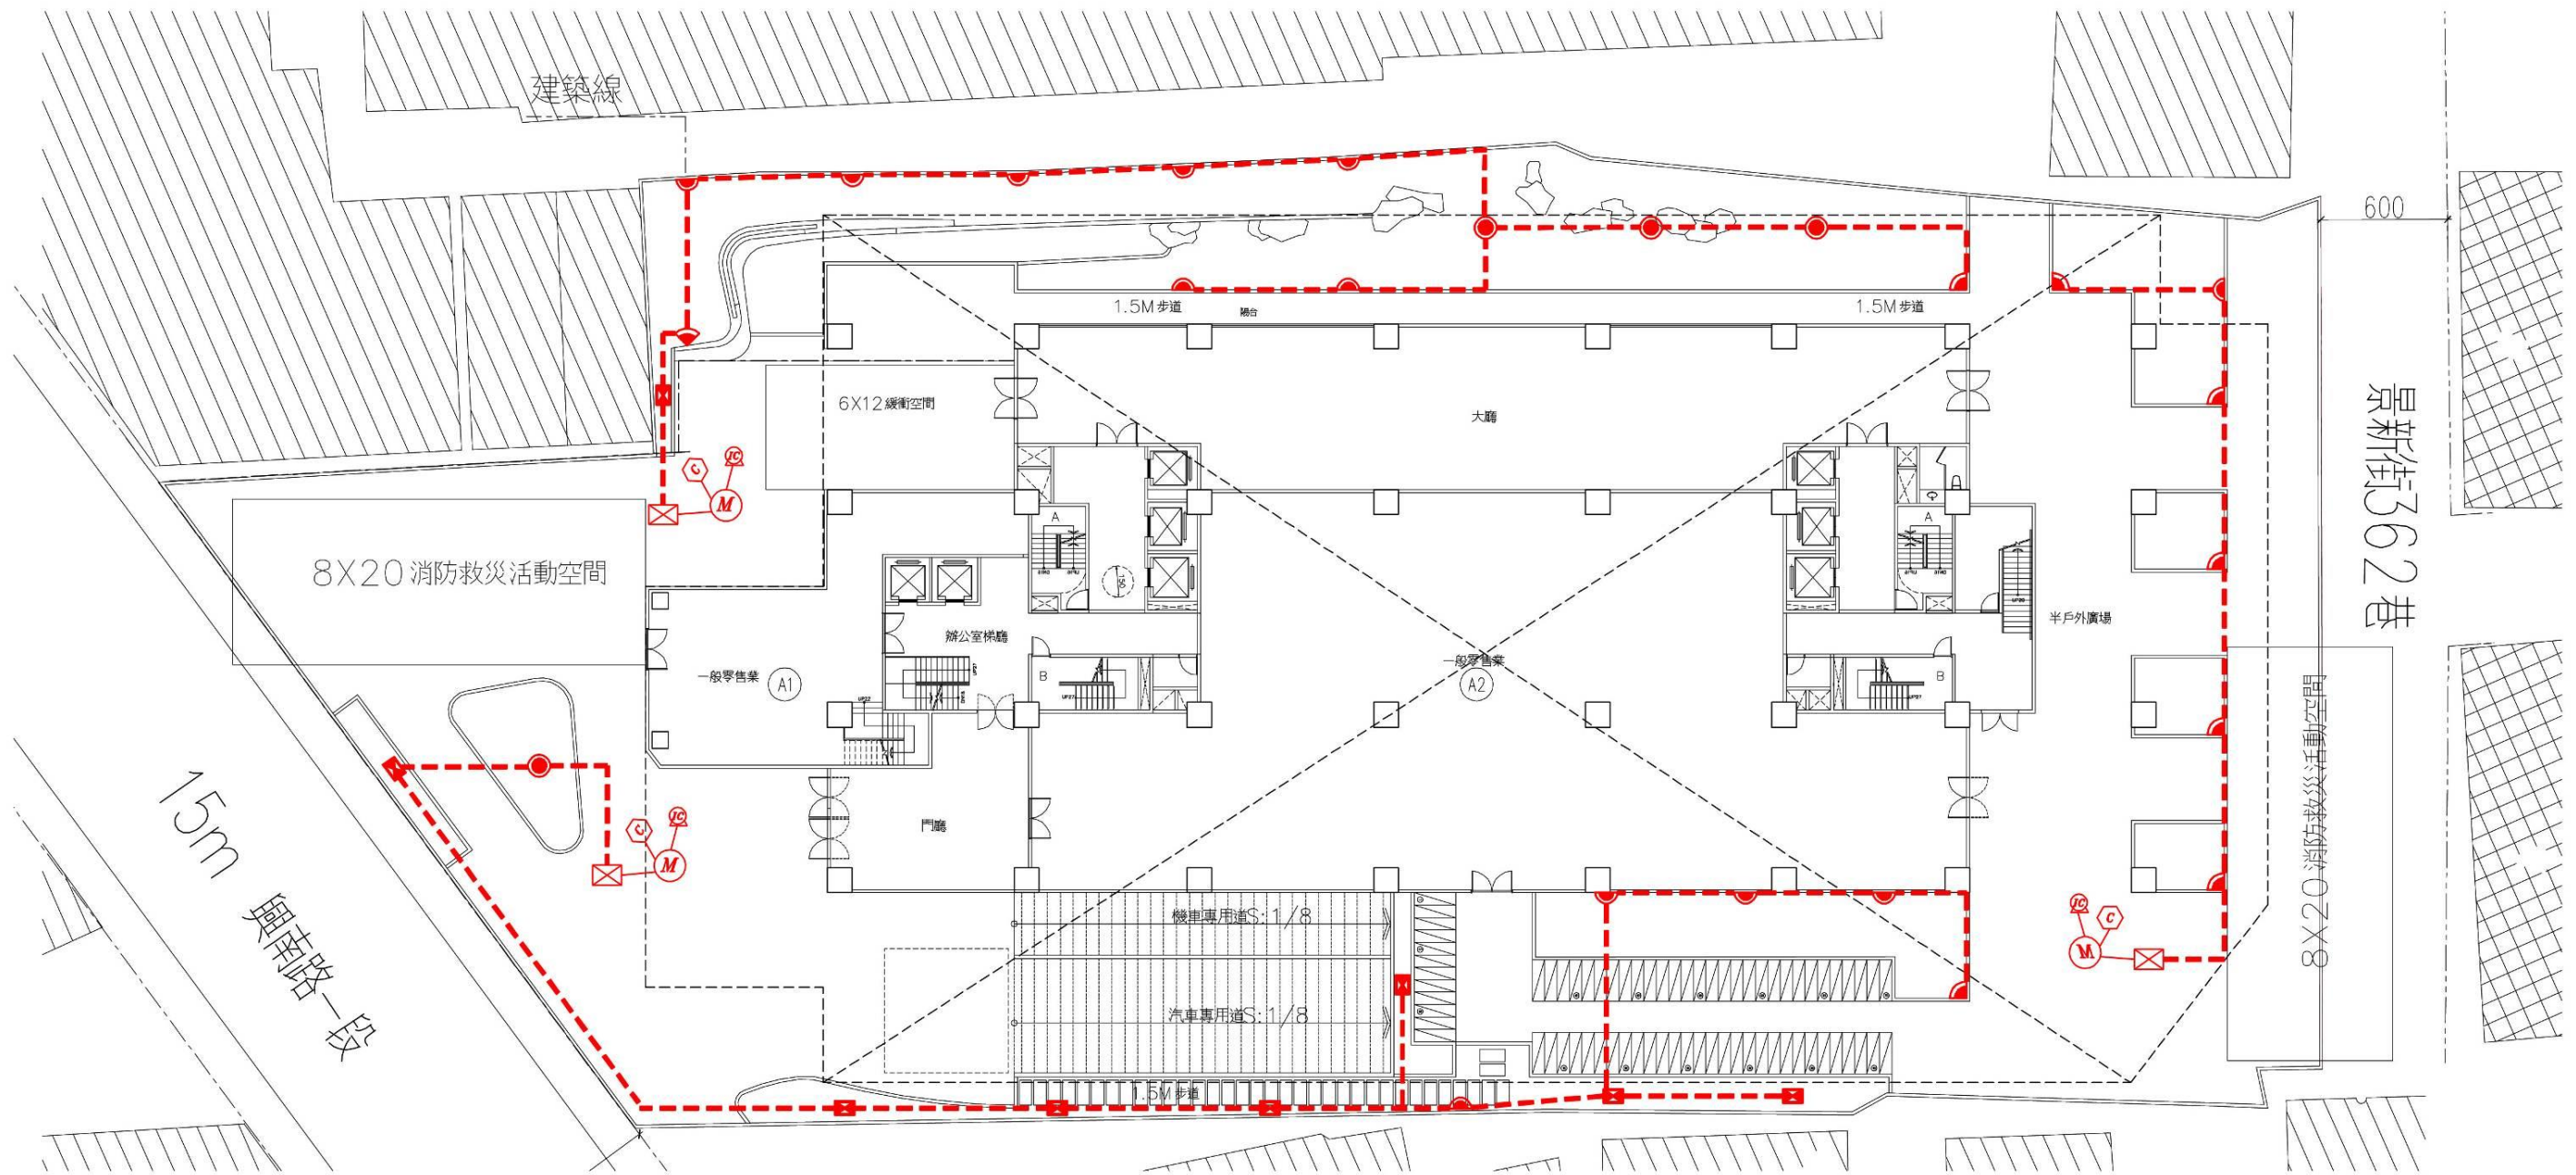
1F 噴灌配置圖圖說 S:1/300
